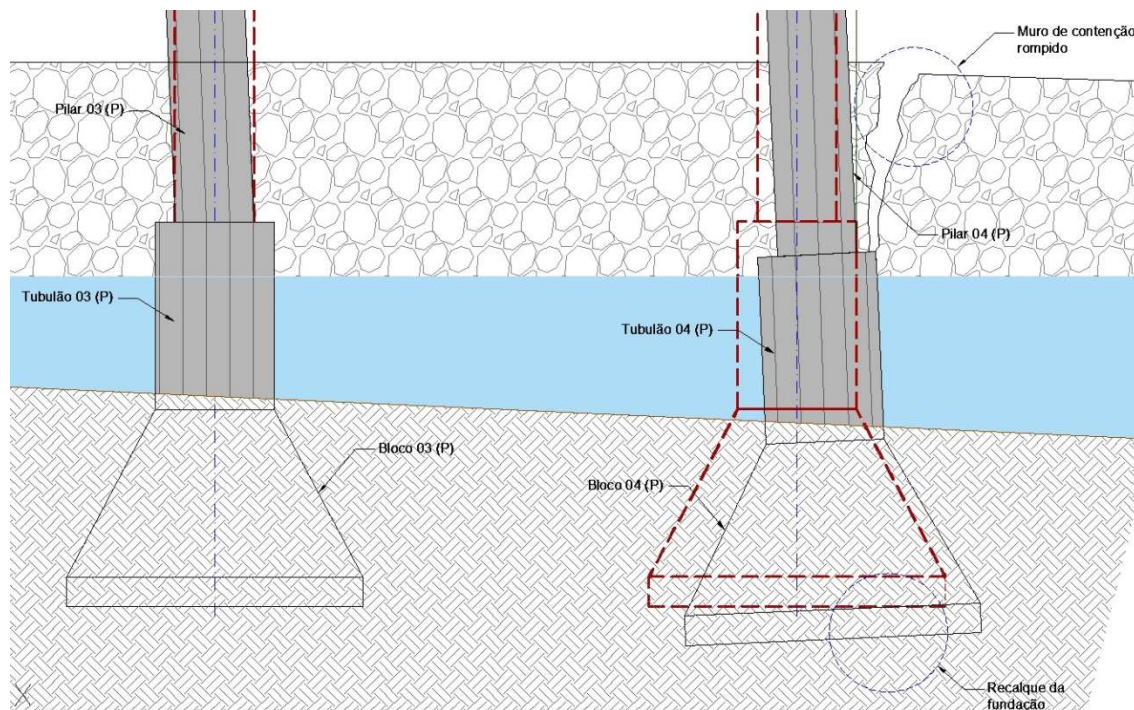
croqui esquemático demonstrando as condições estruturais do pórtico 2.
